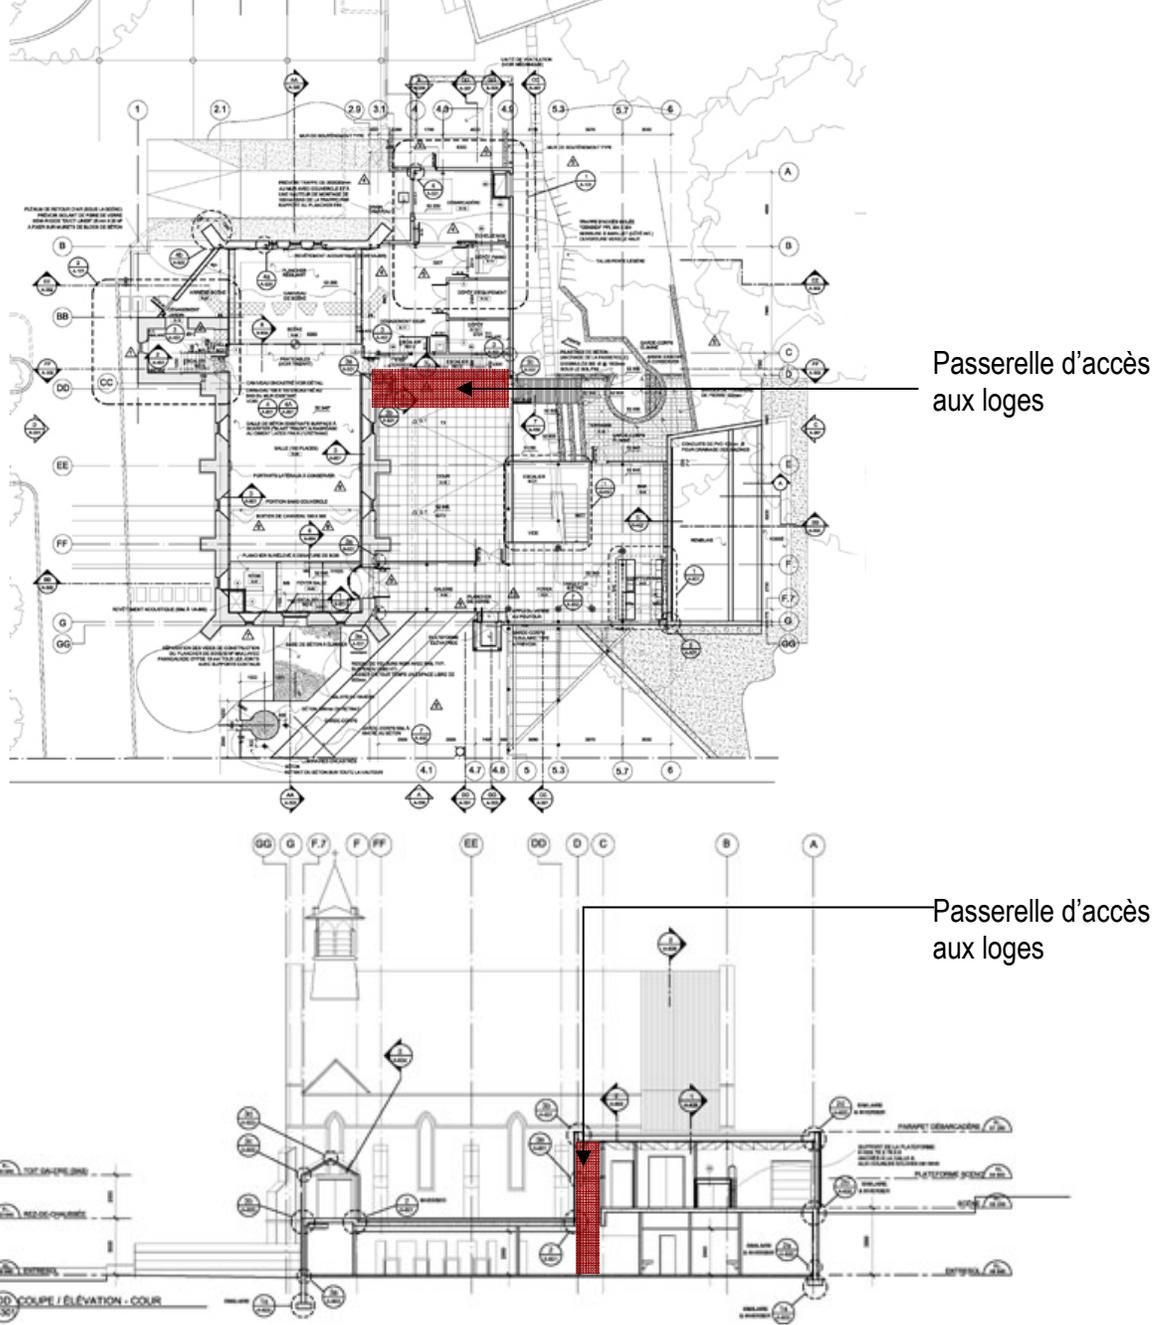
(A) Plan de l'étage et (B) coupe-élévation de la cour (Source: Dan S. Hanganu Architectes)
